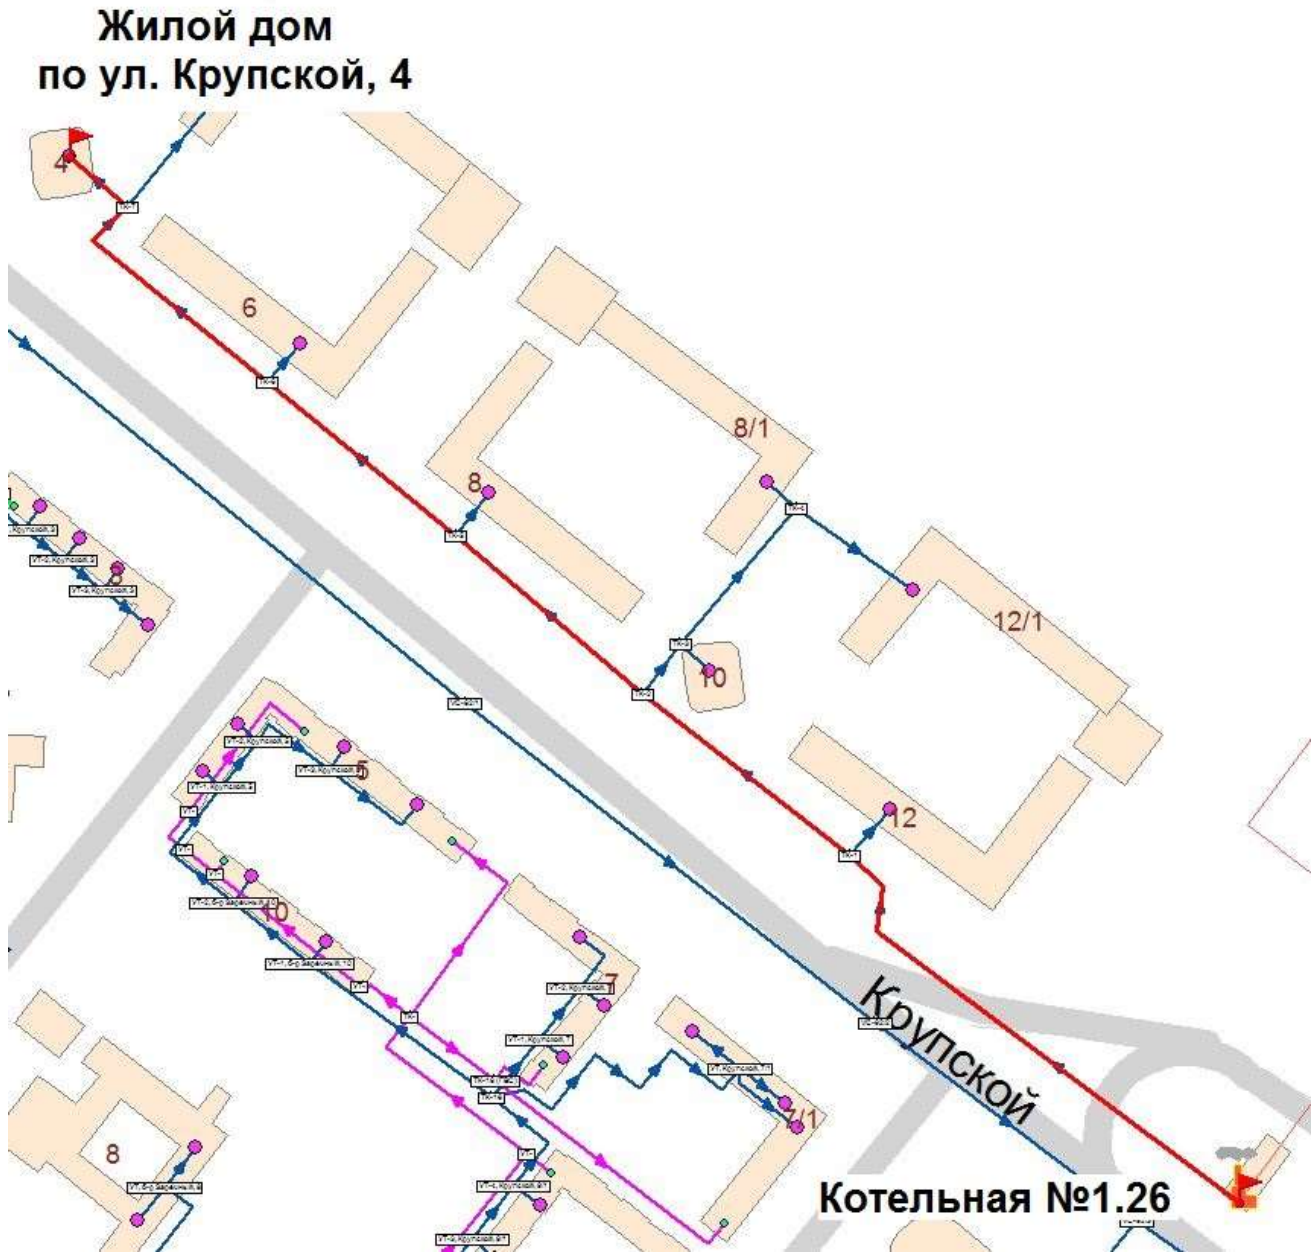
Трассировка теплопровода от Котельной 1.26 до жилого дома по ул. Крупской, 4
